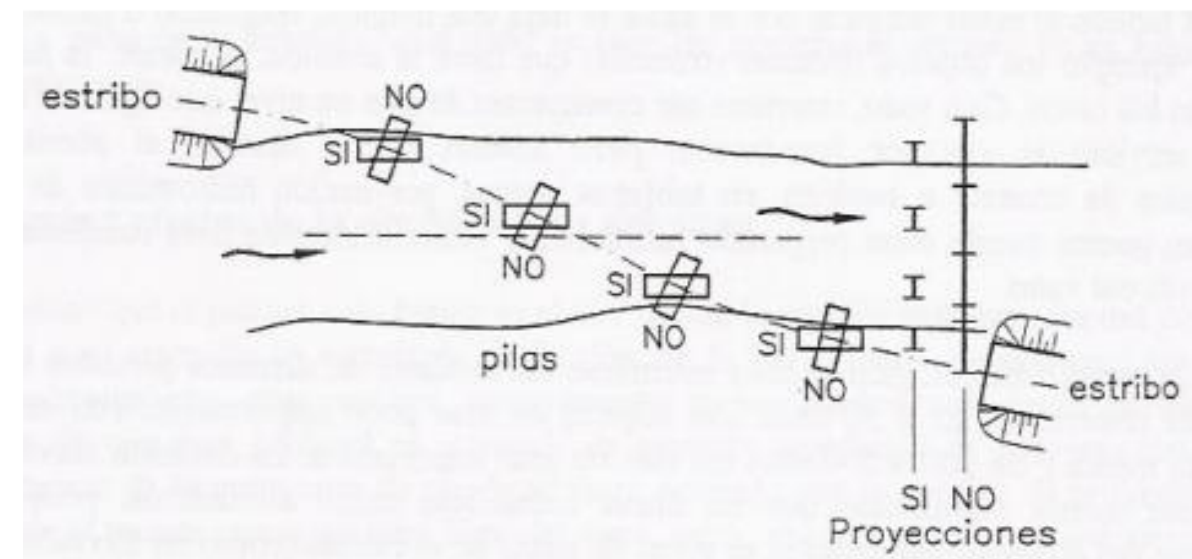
Alineación de pilas y estribos según la corriente. (Fuente: Ingeniería fluvial de Juan P. Martín Vide)
